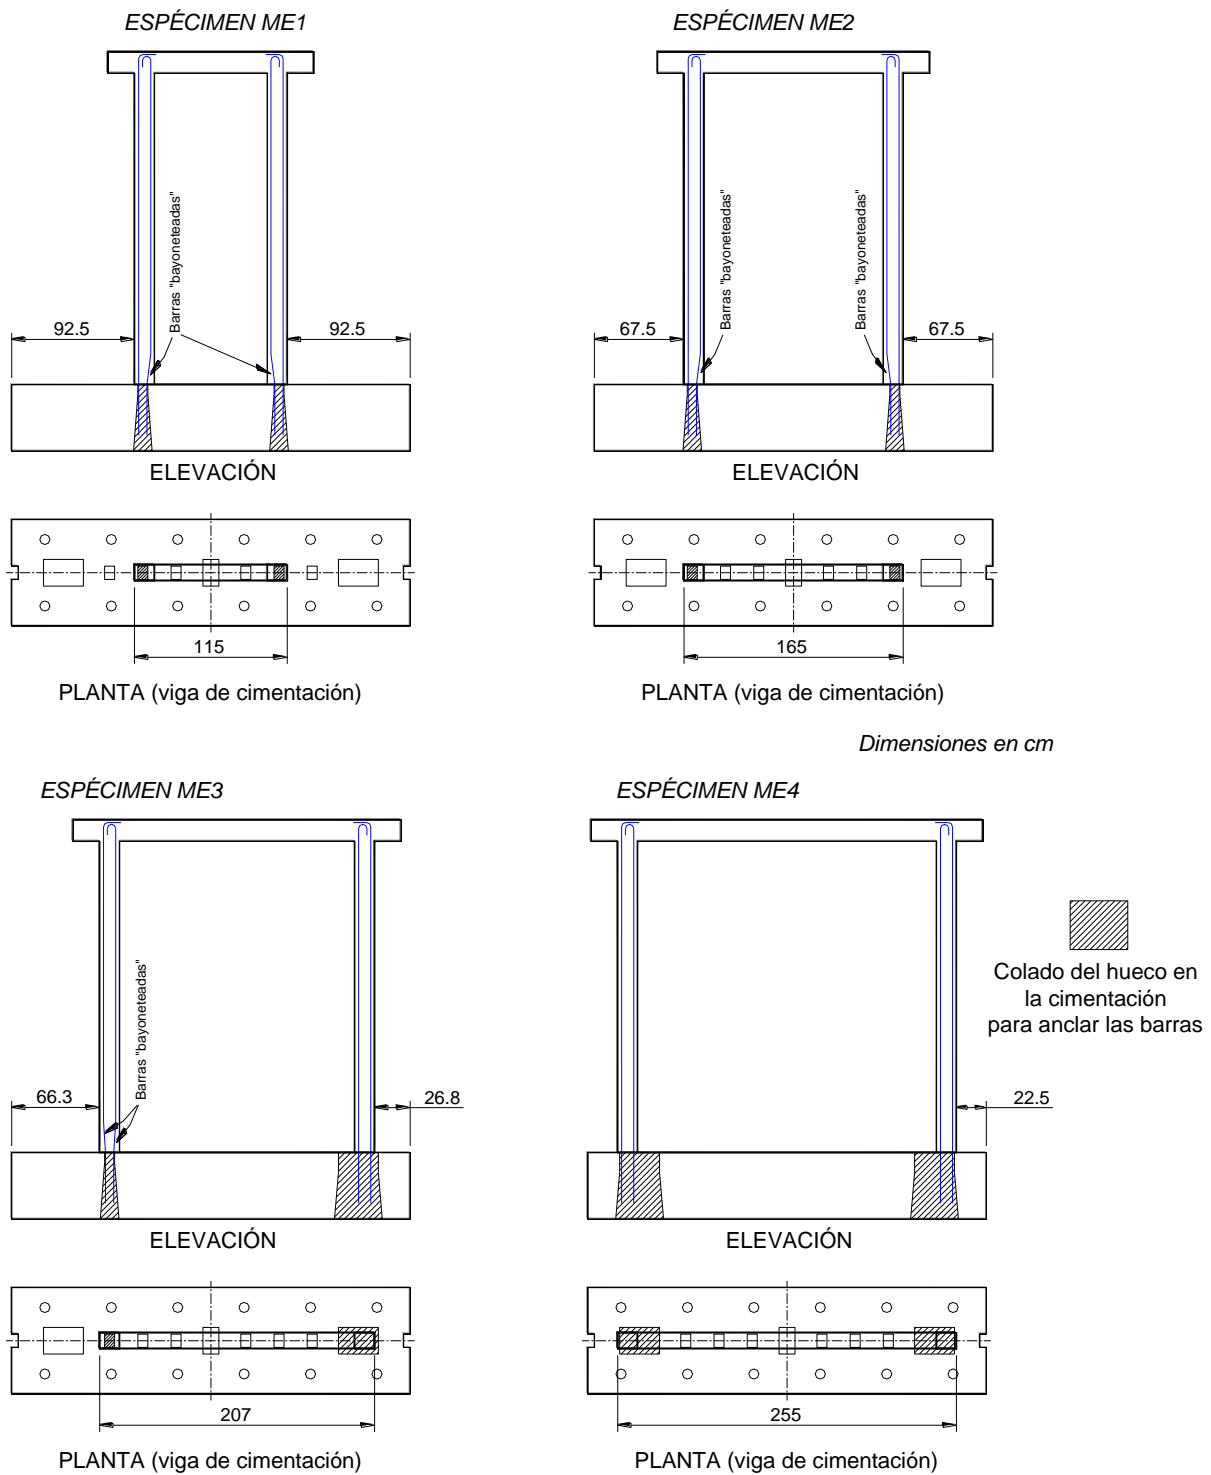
Colocación del armado de los castillos en los huecos de la viga de cimentación
